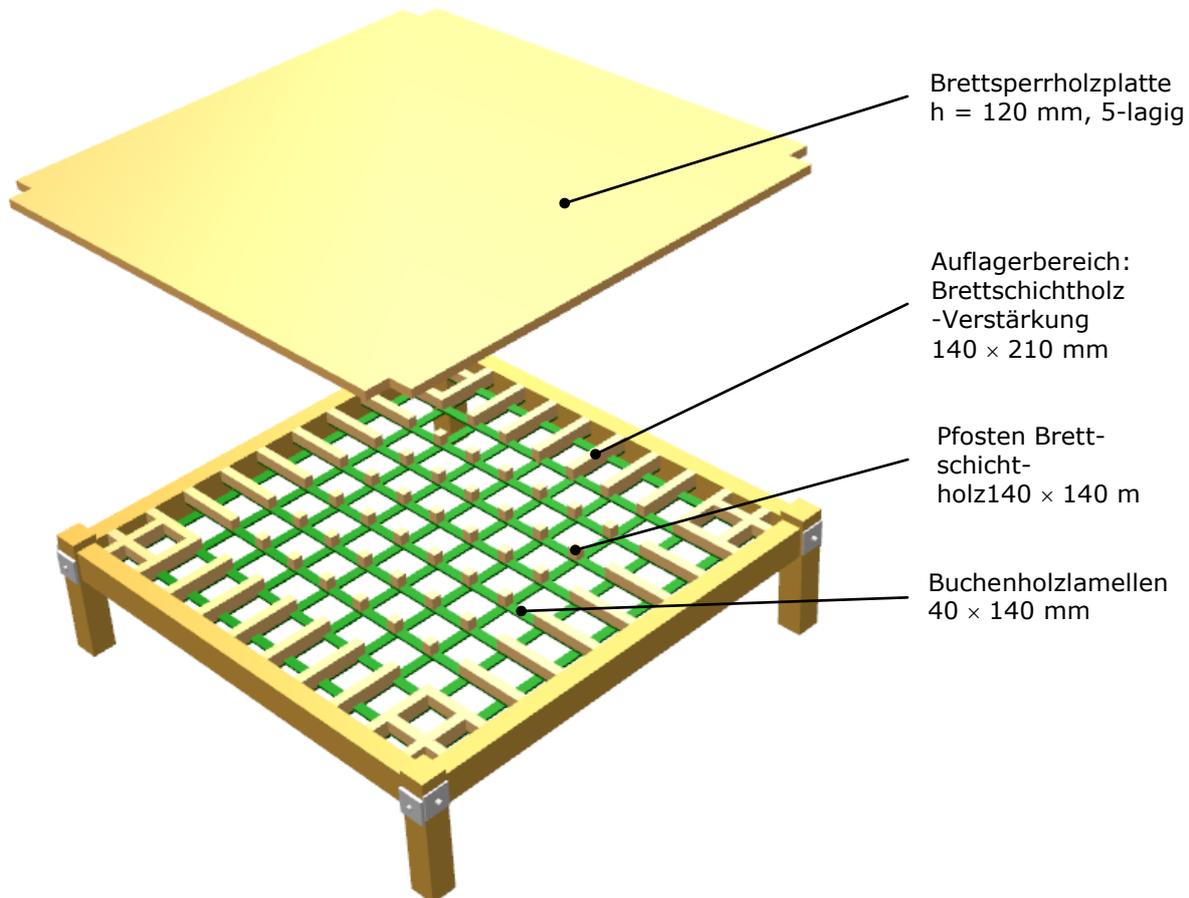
Aufbau der entwickelten zweiachsig lastabtragenden Holzdecke aus Laubholz
